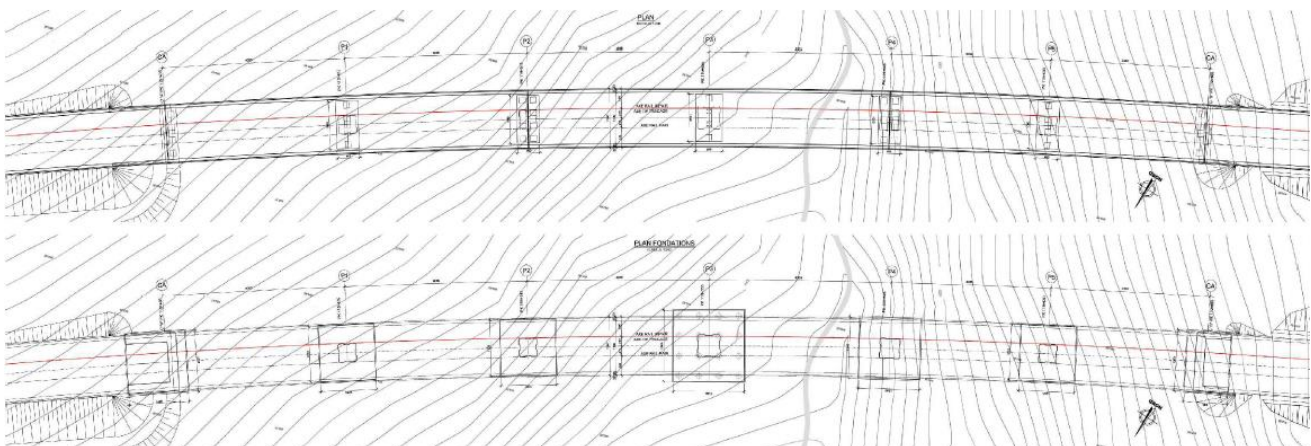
Vue en plan de l'ouvrage en béton armé
